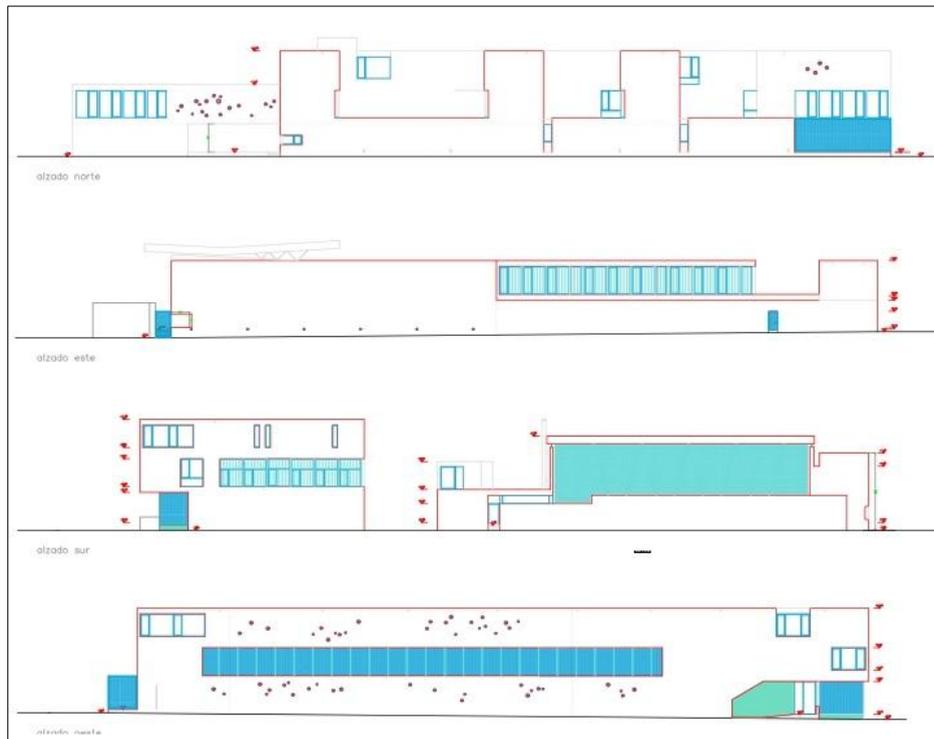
Alzados P. Modificado. Enero 2009. Fuente proyecto de ejecución
